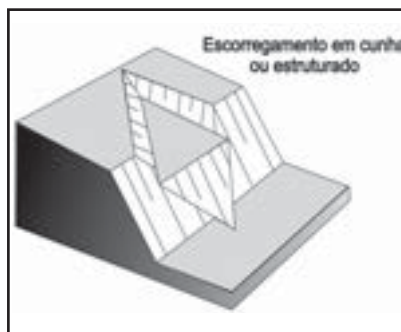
Perfil esquemático de um deslizamento em cunha ou estruturado.
